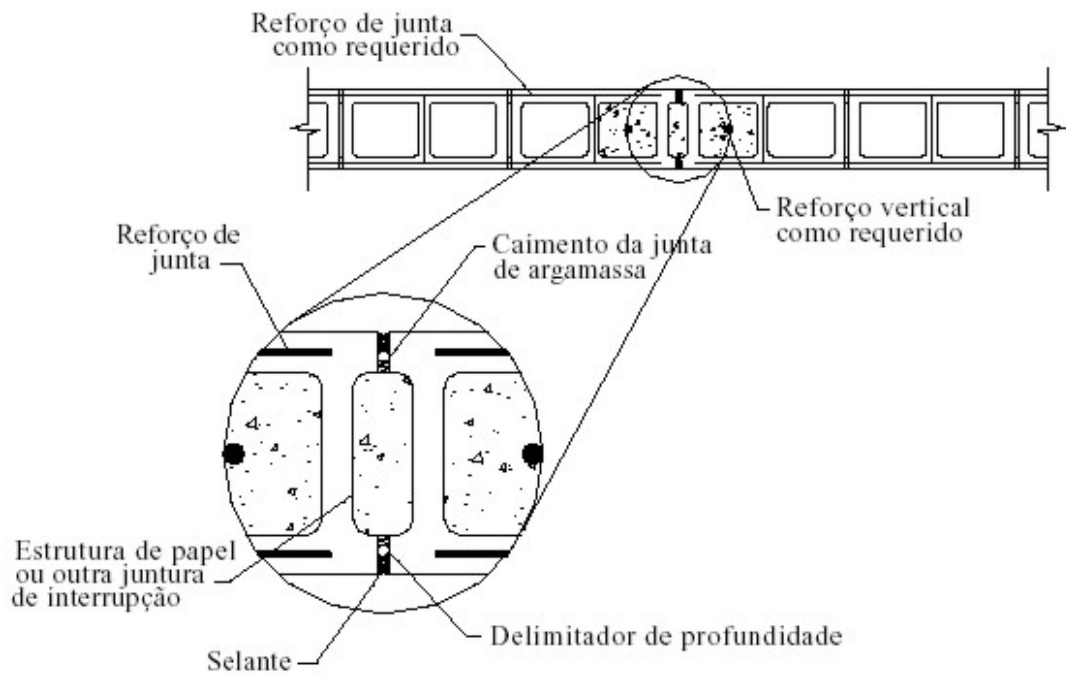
Junta com estrutura de papel (NATIONAL CONCRETE MASONRY ASSOCIATION, 2003a e 2003b)
